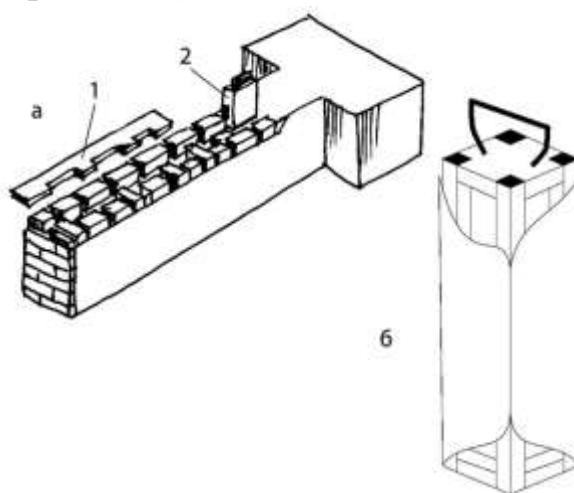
Кладка стены с вентиляционными каналами: а) участок кладки с каналами; б) буюк; 1 – деревянный шаблон; 2 – буюк в канале
